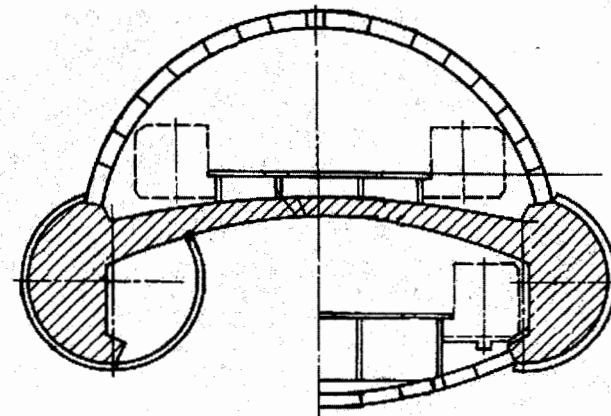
Объединённый двухъярусный односводчатый пересадочный узел с монолитной плитой междуярусного перекрытия
